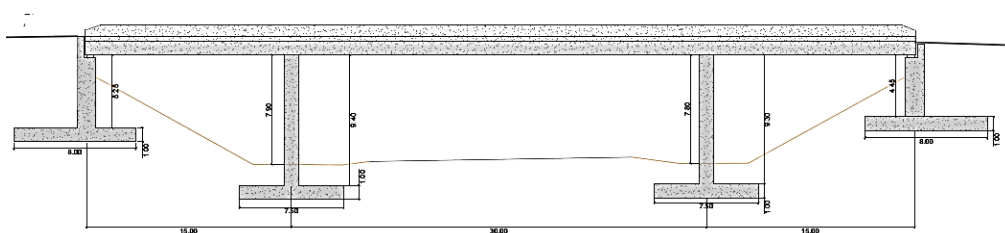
Sección tipo y sección longitudinal del Puente 4
